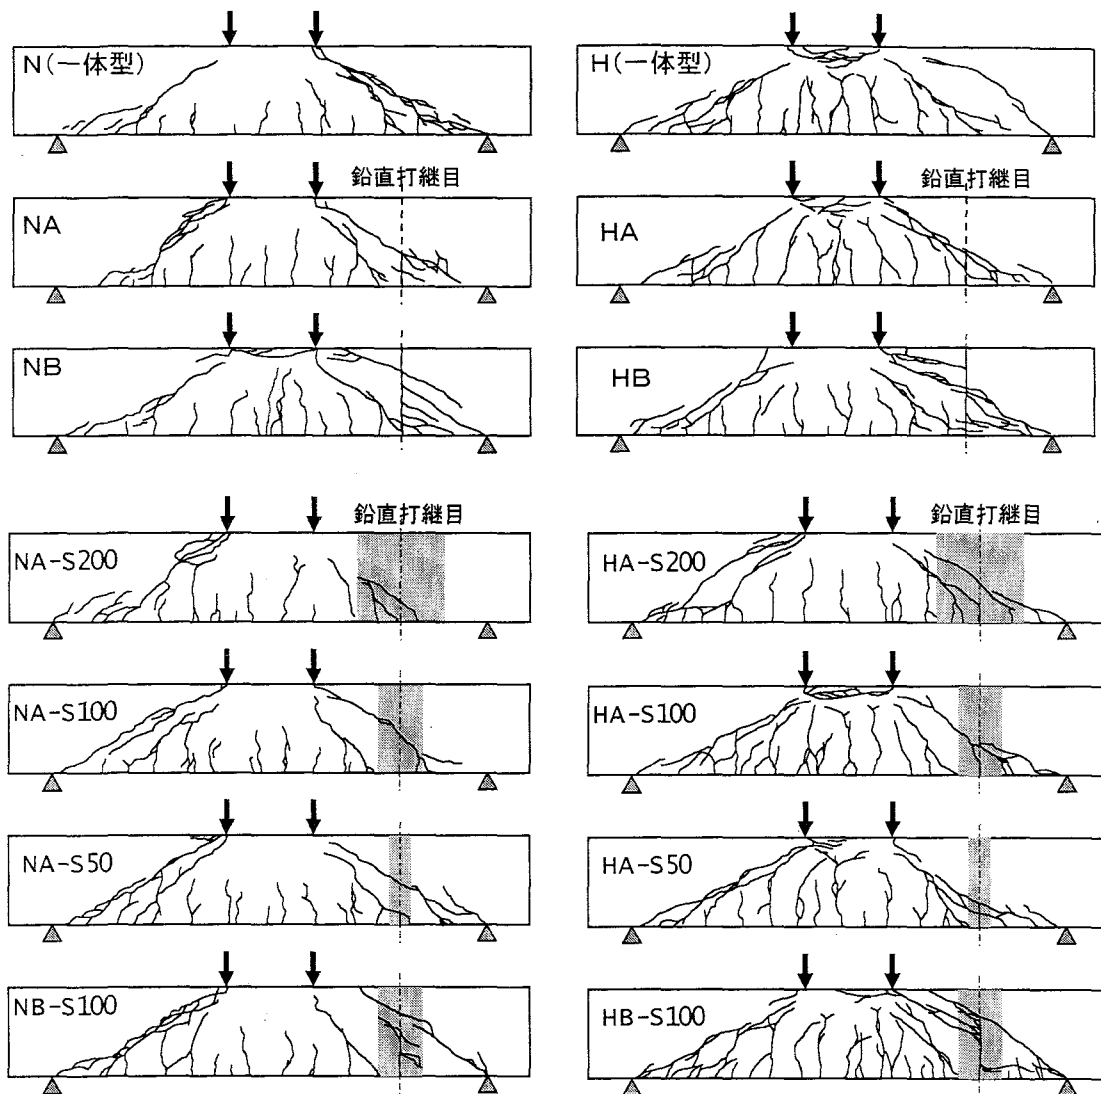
小型RCはりのひび割れ発生状況（破線は打継目位置，網掛けは鋼板被覆）
